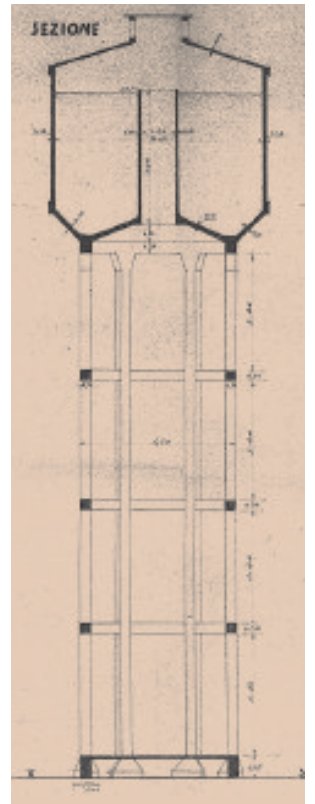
Sezione generale del serbatoio realizzato da Pier Luigi Nervi.
